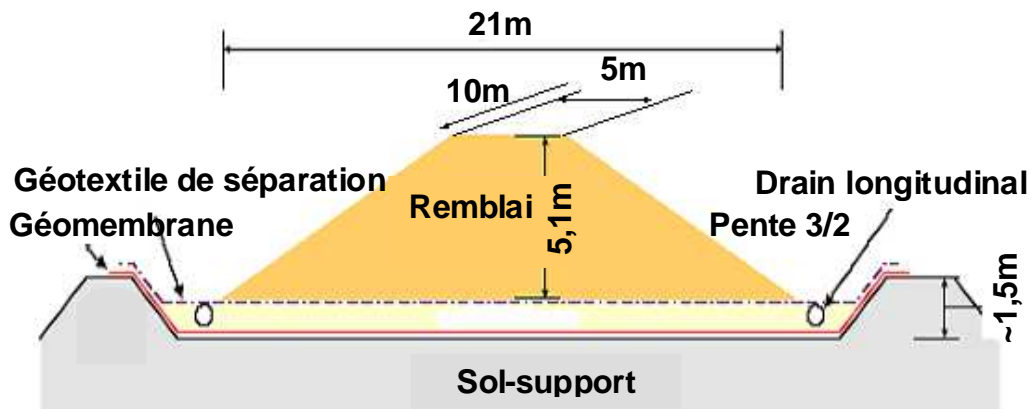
Profil en travers du remblai, structure du dispositif d'étanchéité et de drainage
